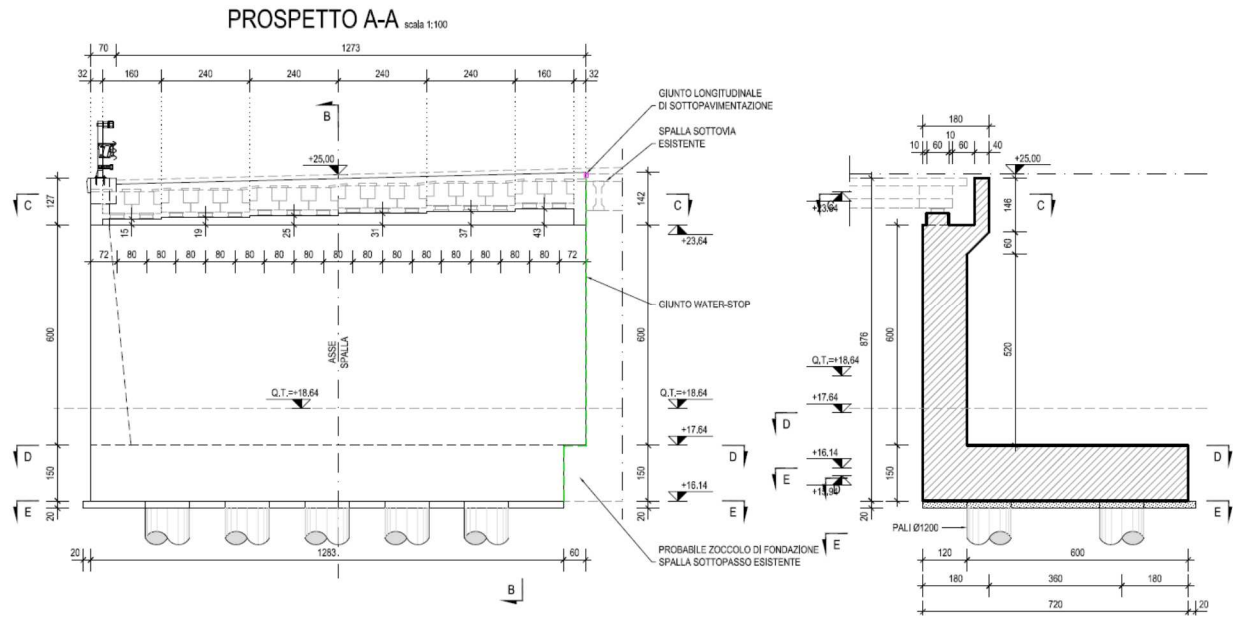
Sezione di carpenteria_Spalla 1
